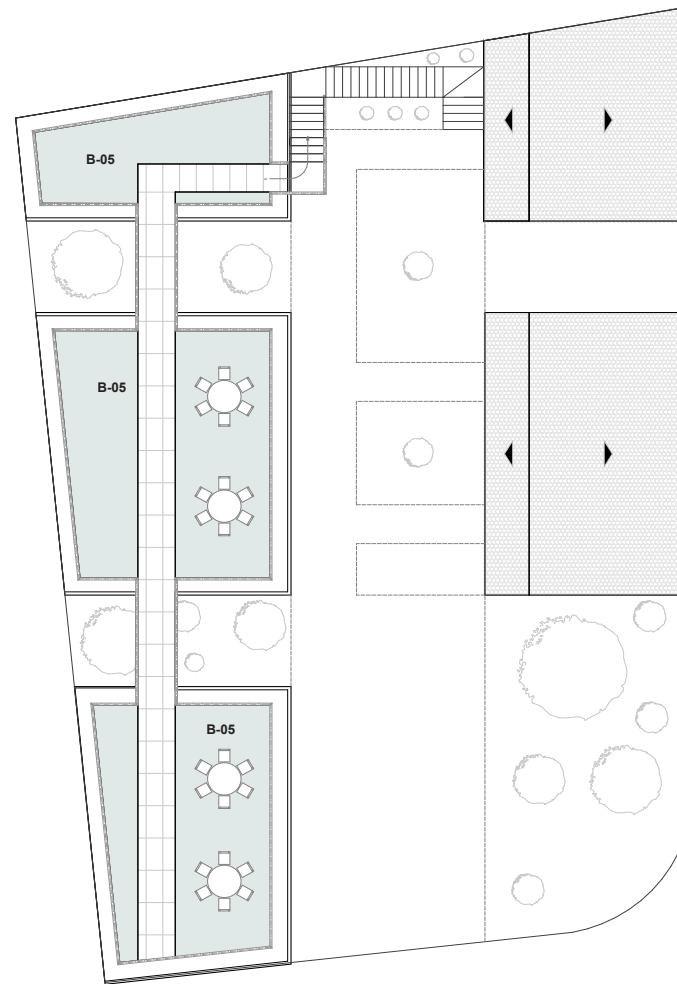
Planta de Cubiertas. Elaborado por Grupo de Tesis.
